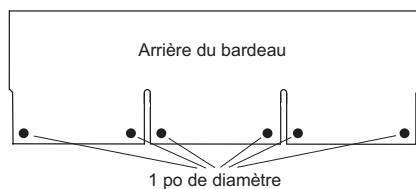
Application de ciment pour toitures sous les coins des languettes.
